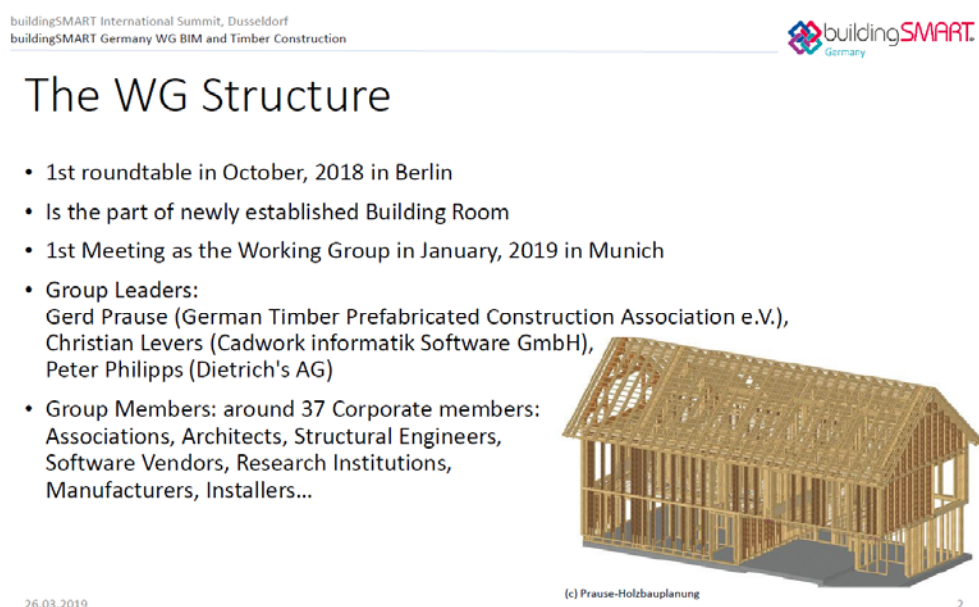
buildingSMART ドイツ支部の木造 BIM ワーキンググループ活動報告資料（抜粋）
